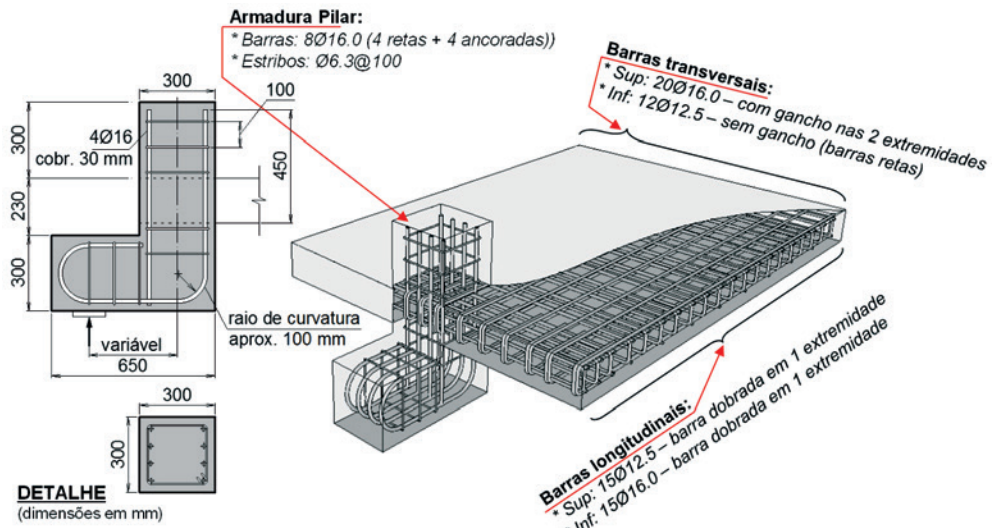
Esquema de distribuição das armaduras no pilar e na laje
